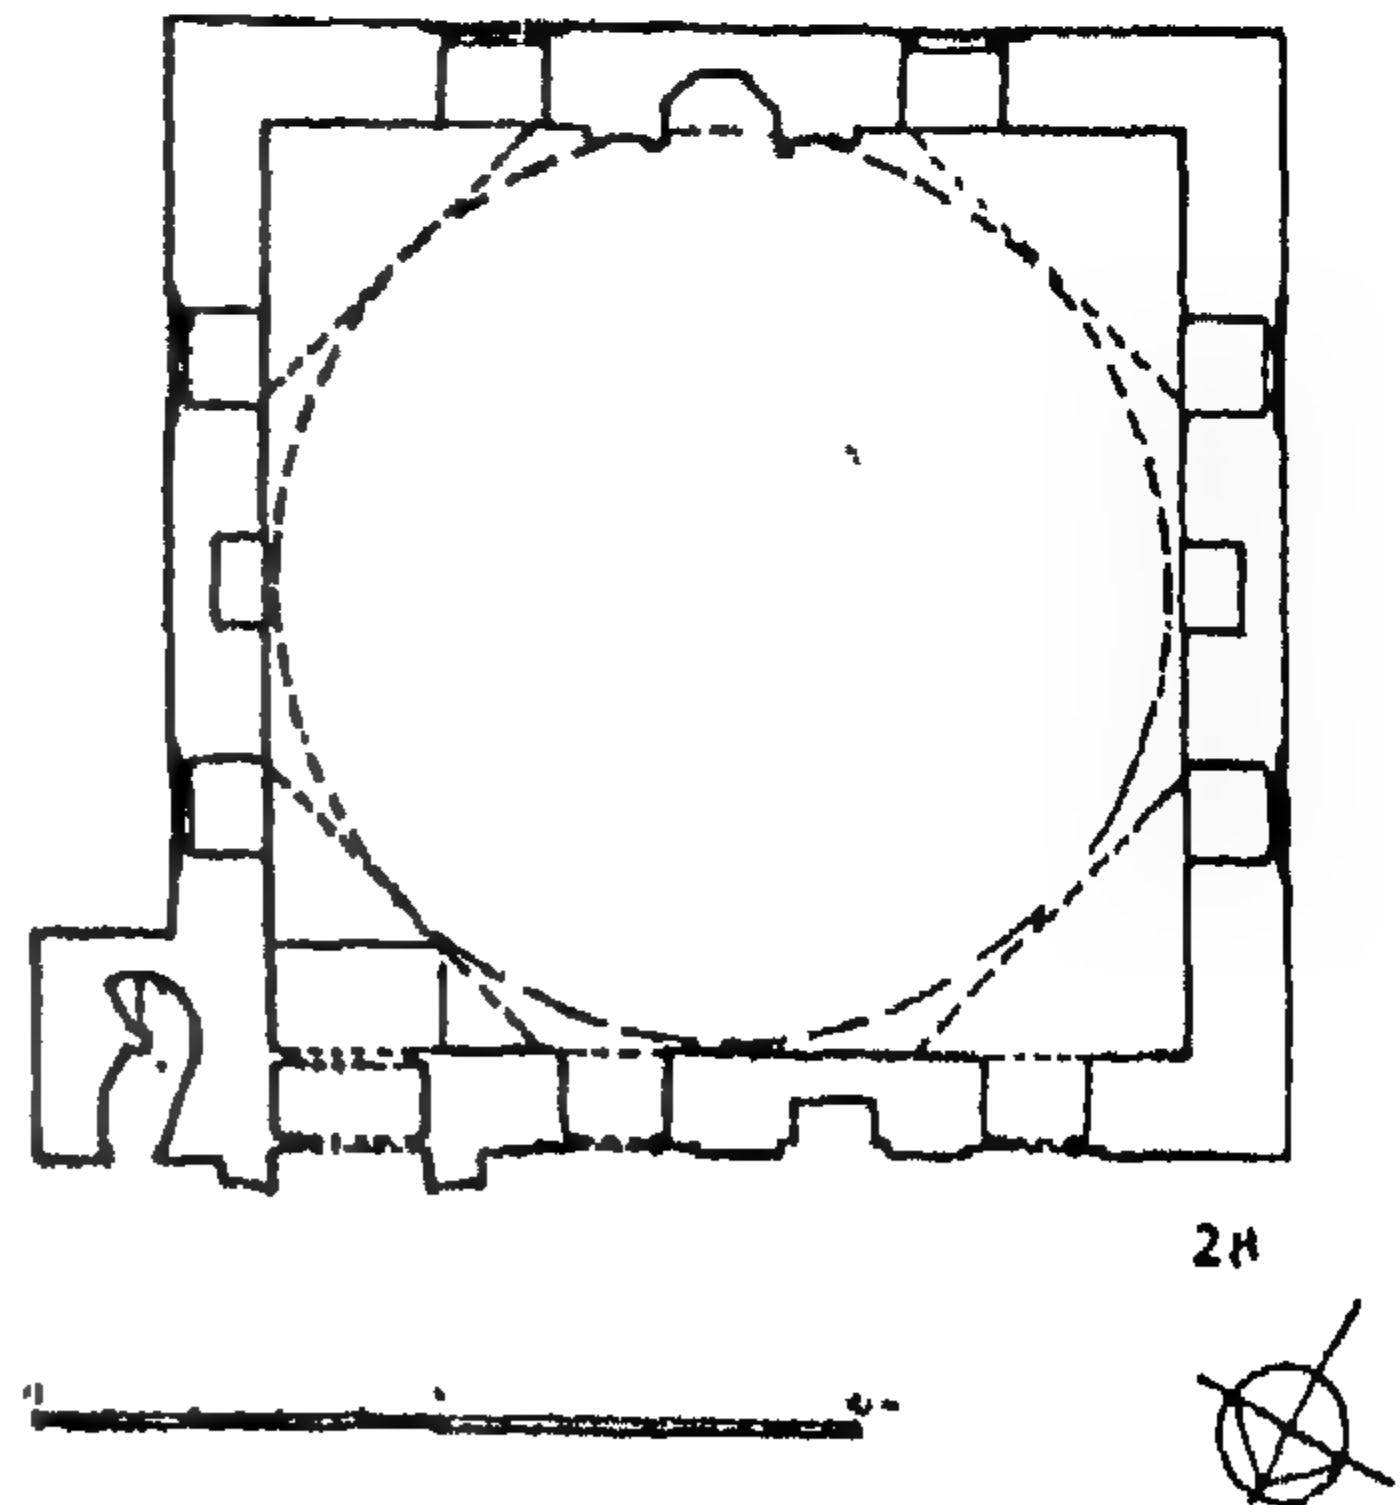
مسقط أفقي لجامع فيروز أغا
